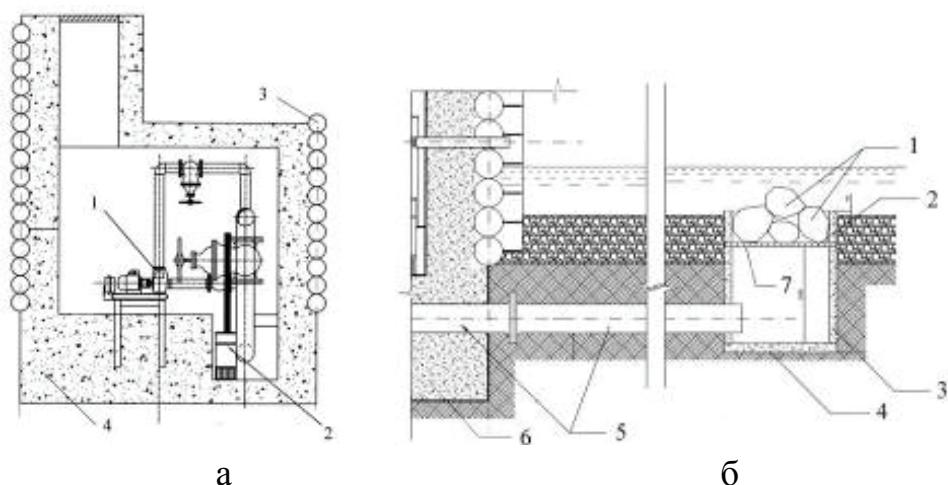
Насосная в мельничной плотине на р. Жужа: а – расстановка оборудования; 1 – насос КМ 160/20; 2 – дренажный насос «Гном»; 3 – стены ряжа; 4 – железобетонный бункер; б – конструкция водозабора в НБ: 1 – камень булыжный; 2 – сталь листовая $t = 20$ мм; 3 – колодец КЦ-10; 4 – днище колодца КЦД-10; 5 – водозаборная труба диаметром 300 мм; 6 – насосная
